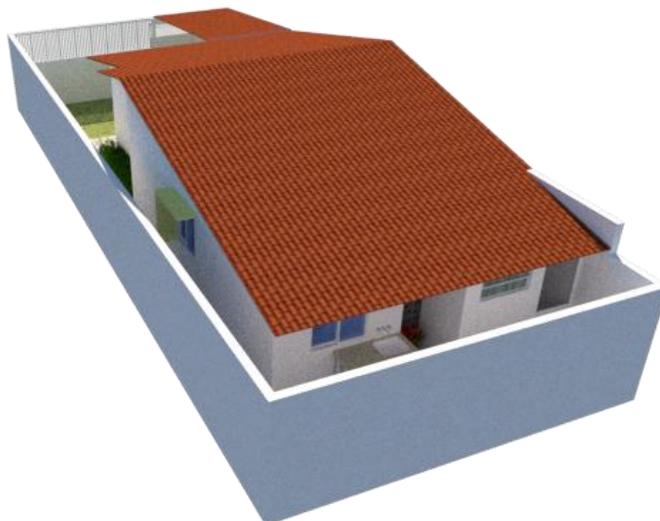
Proposta orientada à Sudoeste - Fachada lateral
